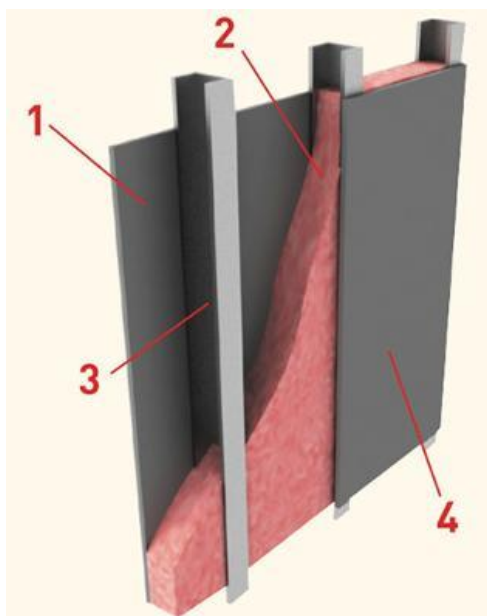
Утепленная перегородка: 1, 4 – листы из гипсокартона, 2– тепловая изоляция, 3 – каркас из металлического профиля
